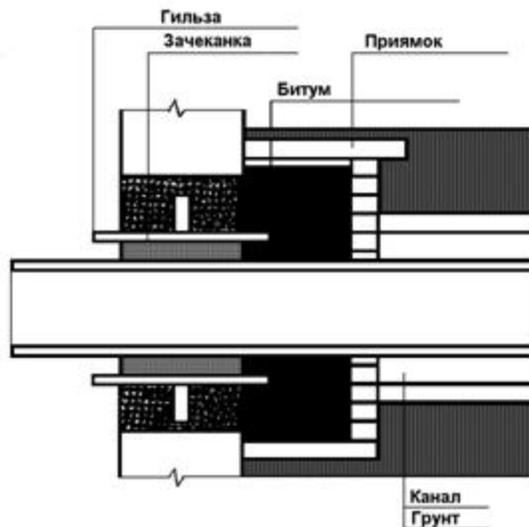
Герметизация узла ввода-вывода трубопровода в здание
